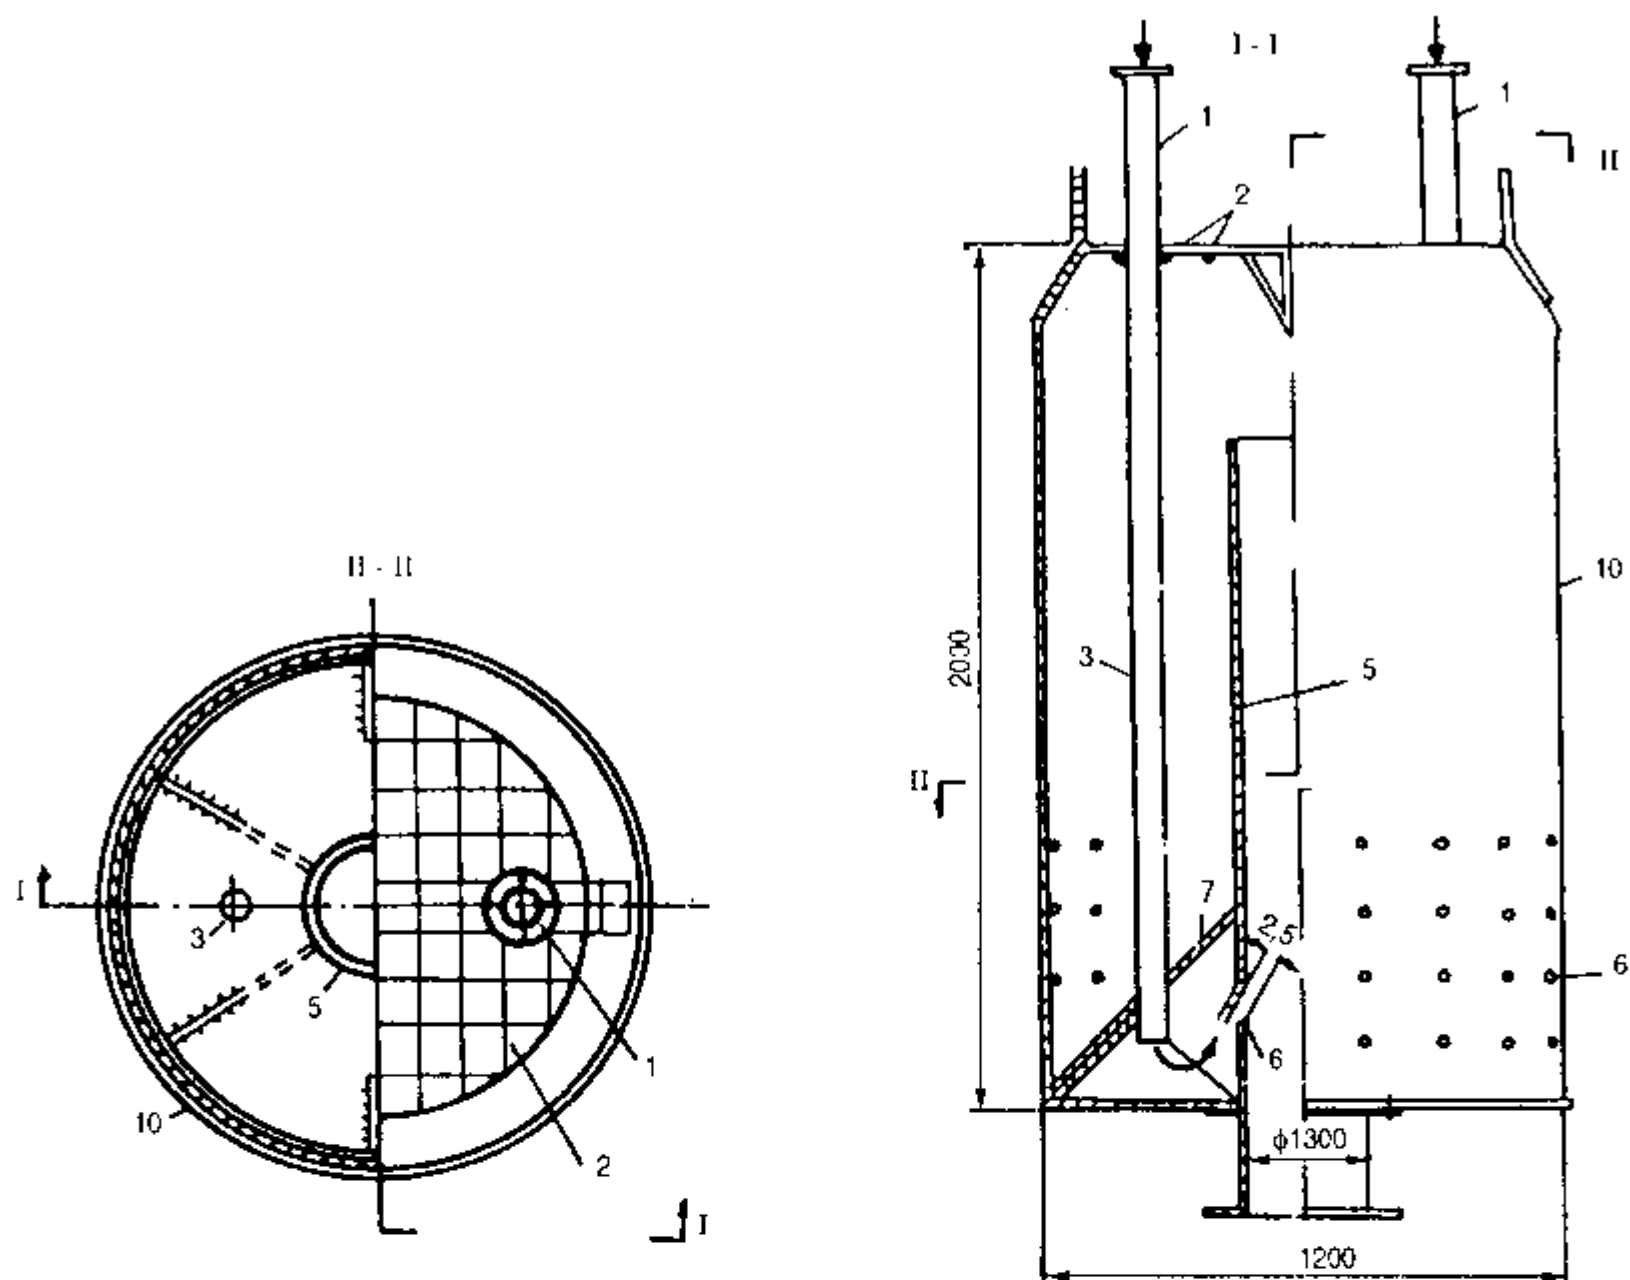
Sơ đồ bố trí máy hút bùn và ống xói
